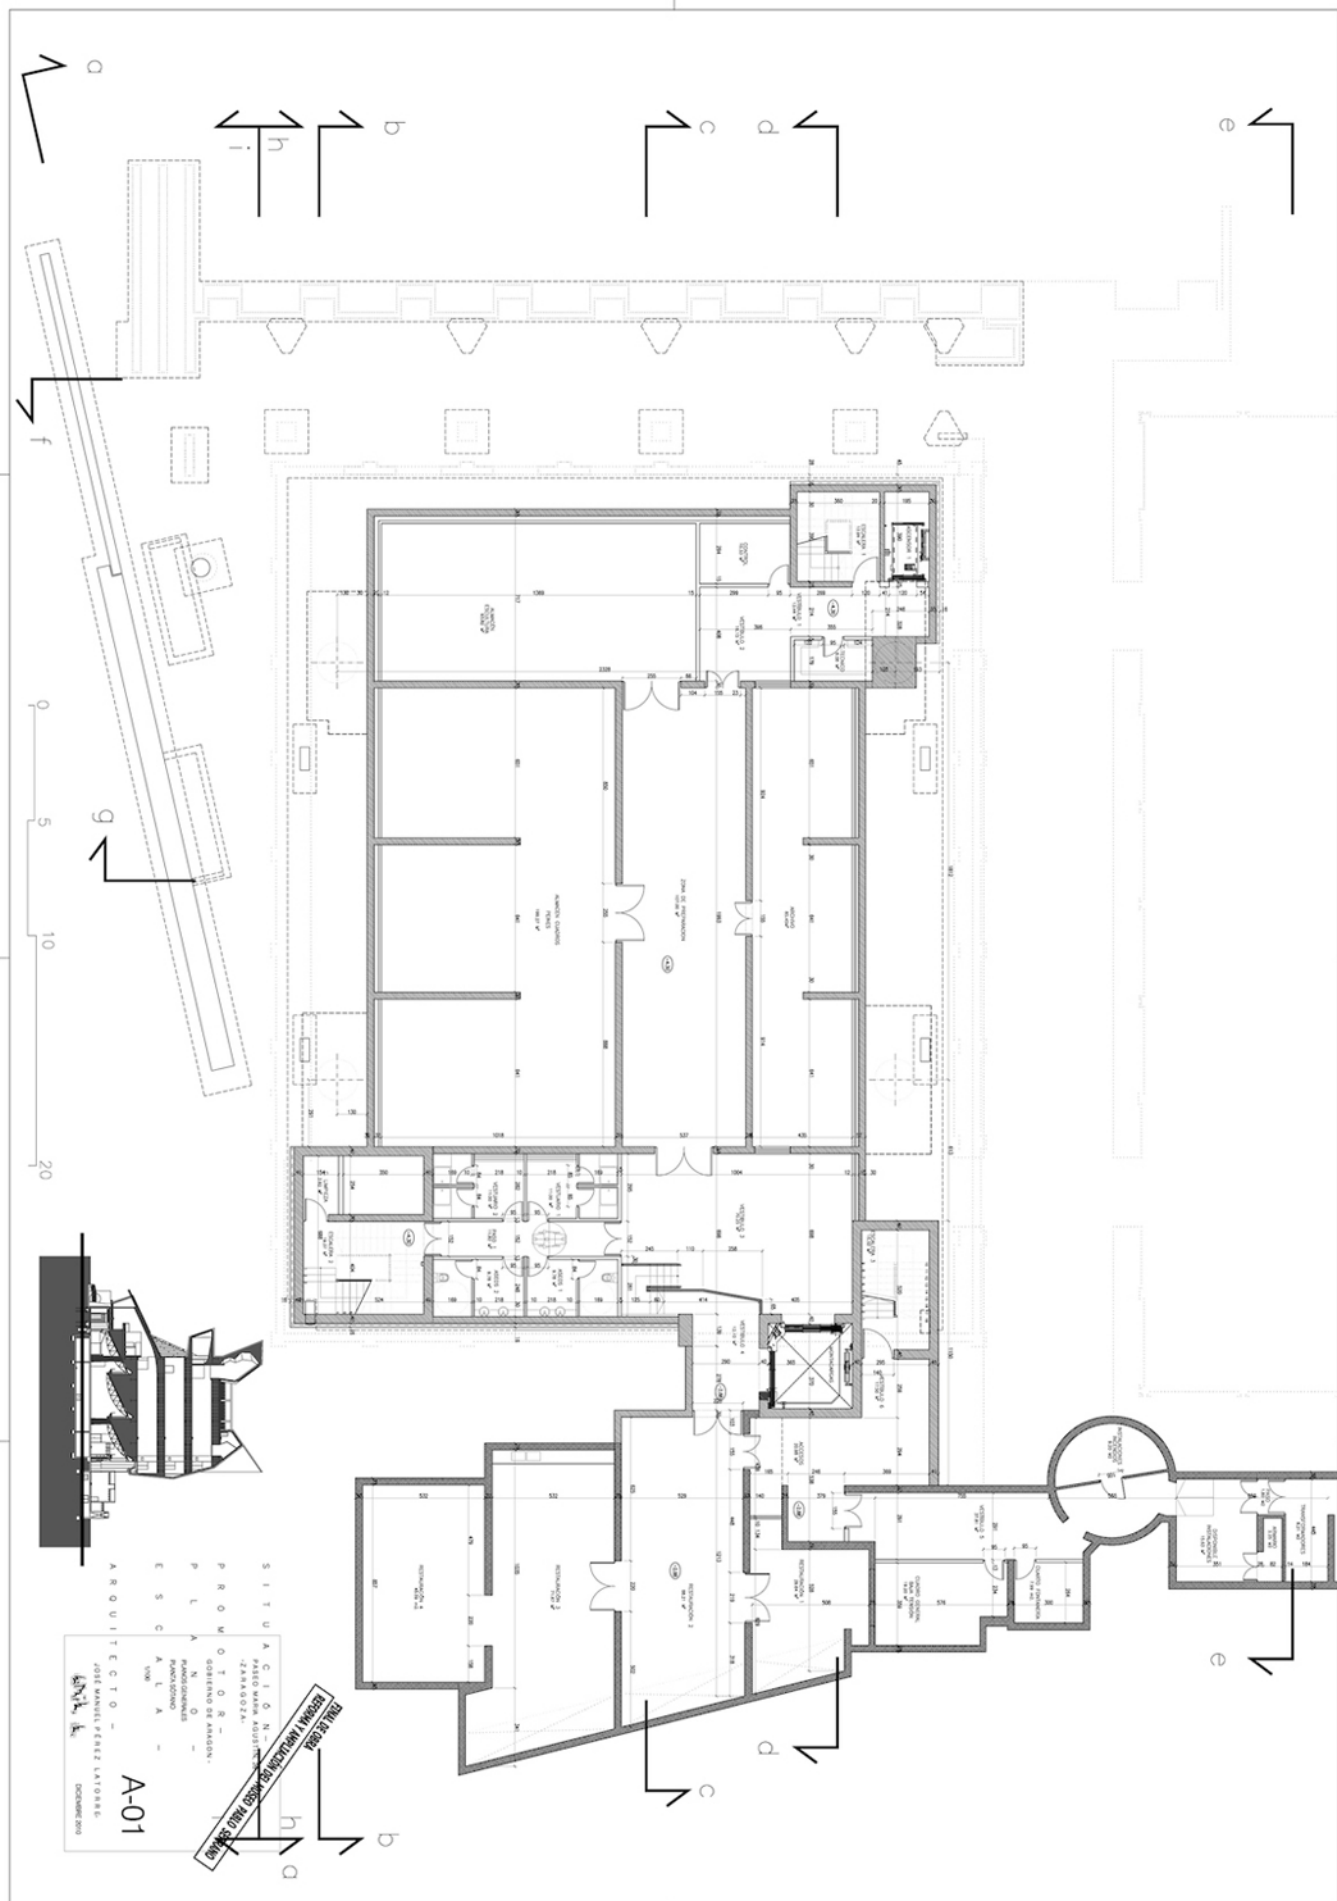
Planta sótano (según J.M. Pérez Latorre)
